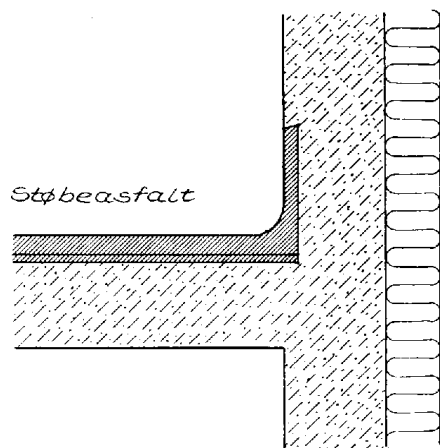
Inddækning med støbt rille til asfalt mellem betonmur og betontag med asfalt.
